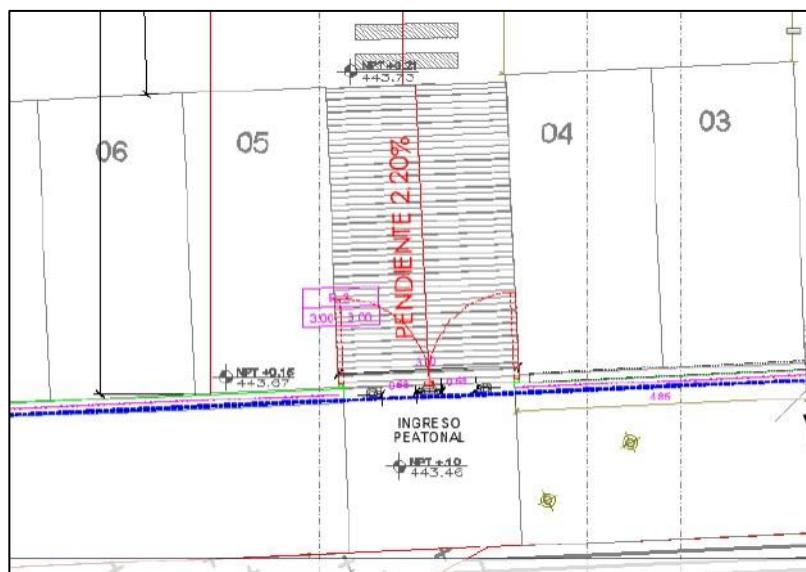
Plano Arquitectura con niveles Topográficos – Ingreso al Supermercado.
